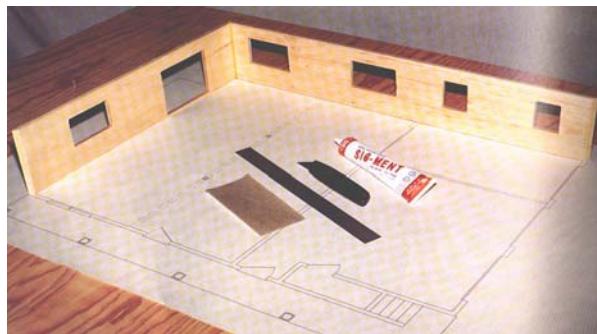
مسقط أفقي للدور الأول.
